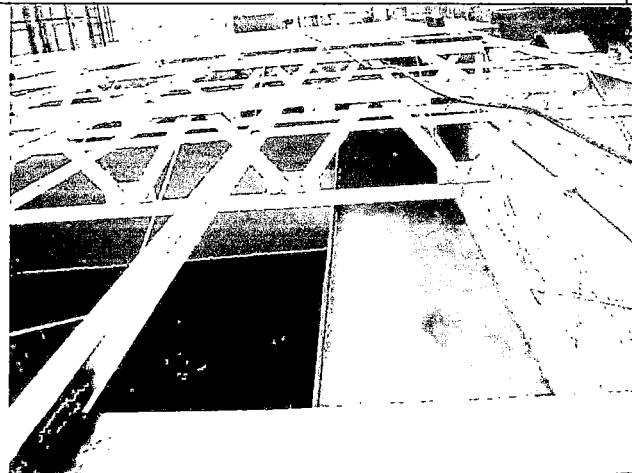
Se terminaron los trabajos de soldadura
